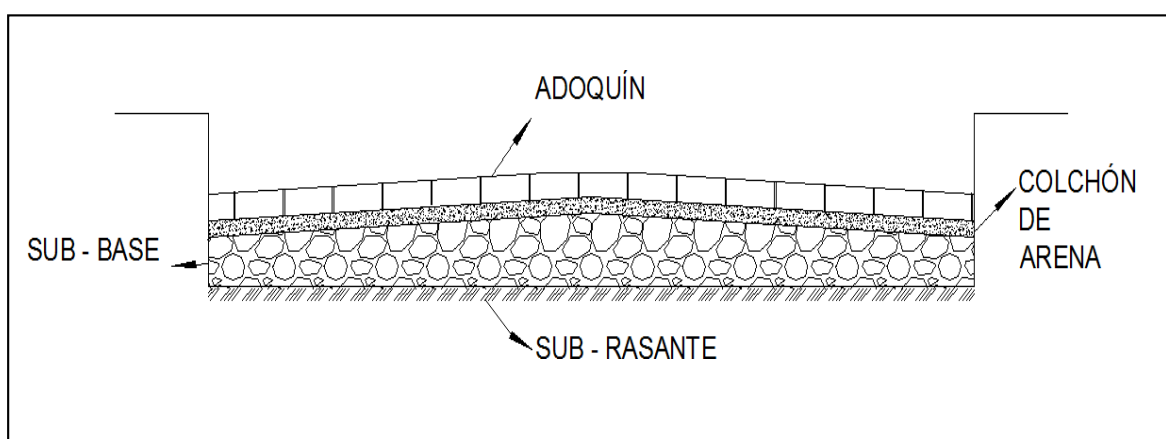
Estructura de pavimento híbrido - Fuente especificada no válida.
